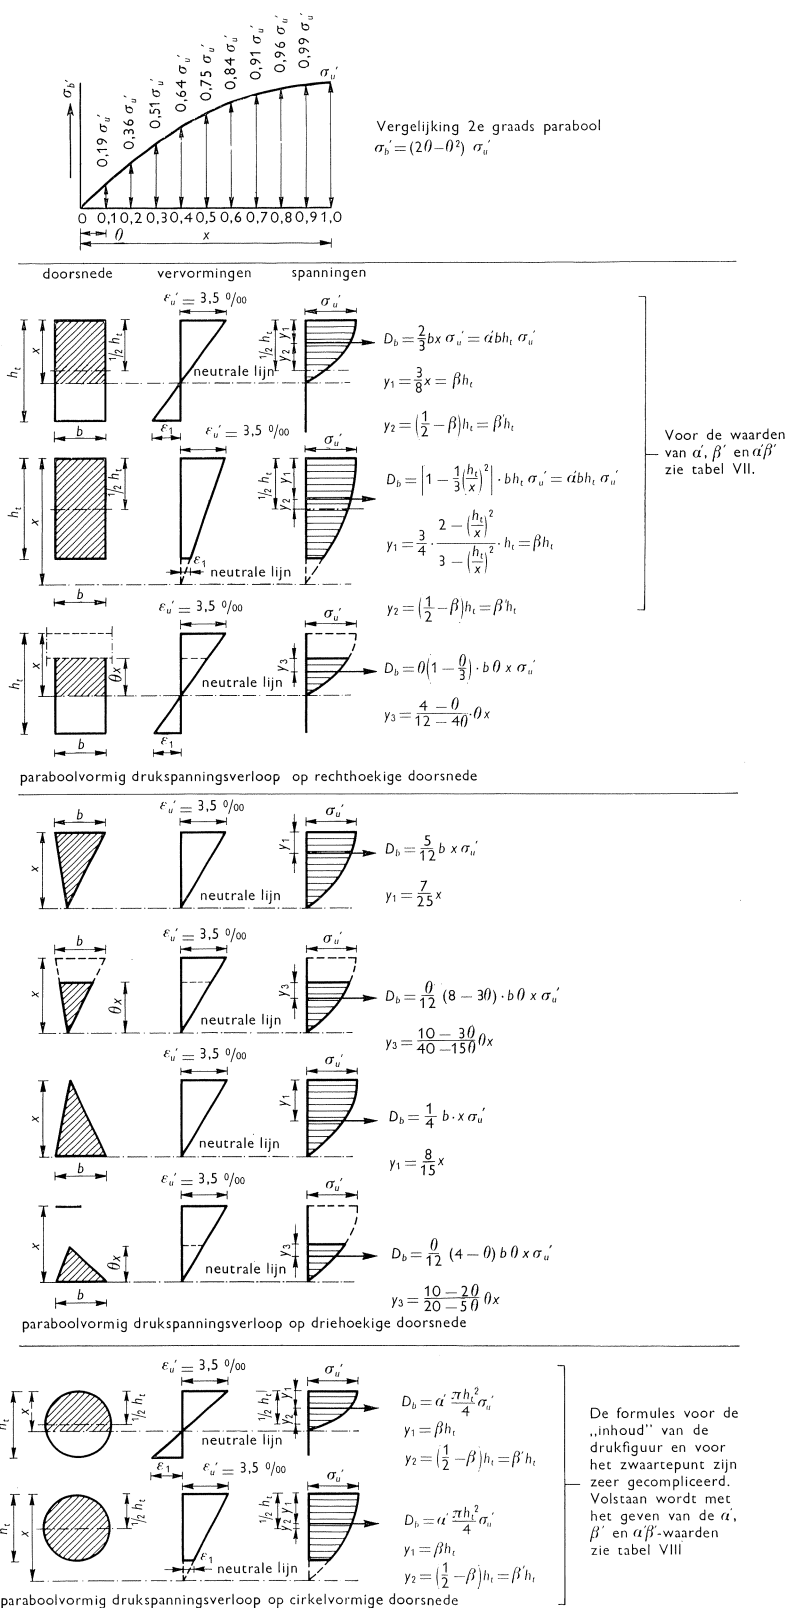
Enige gegevens betreffende het paraboolvormig spanningsverloop van de betondrukzone.
